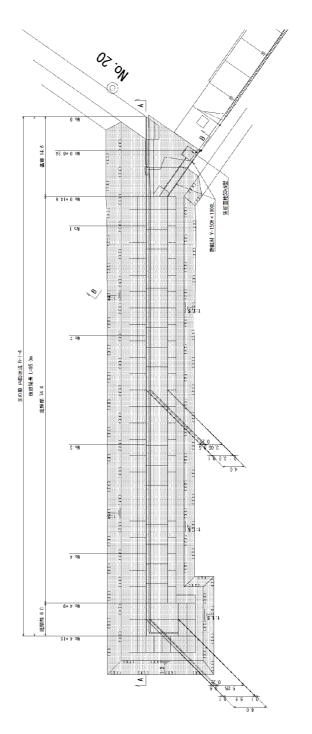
No.12 玉の脇地区_内防波堤の平面図(復旧後)
